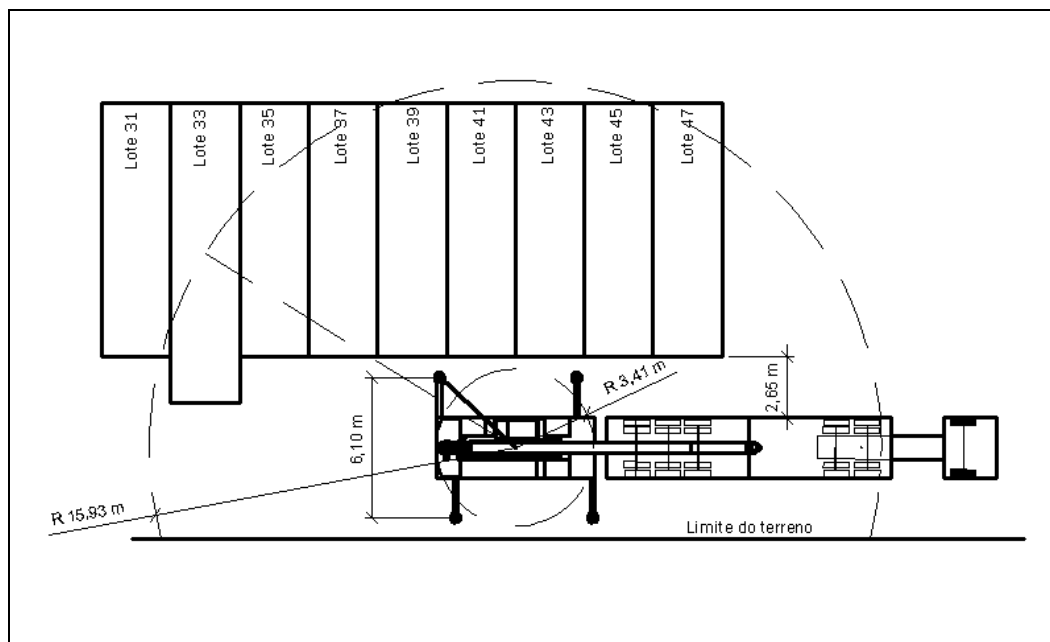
Planta com o posicionamento do guindaste e carreta para a movimentação de carga nos lotes 33 a 47.
